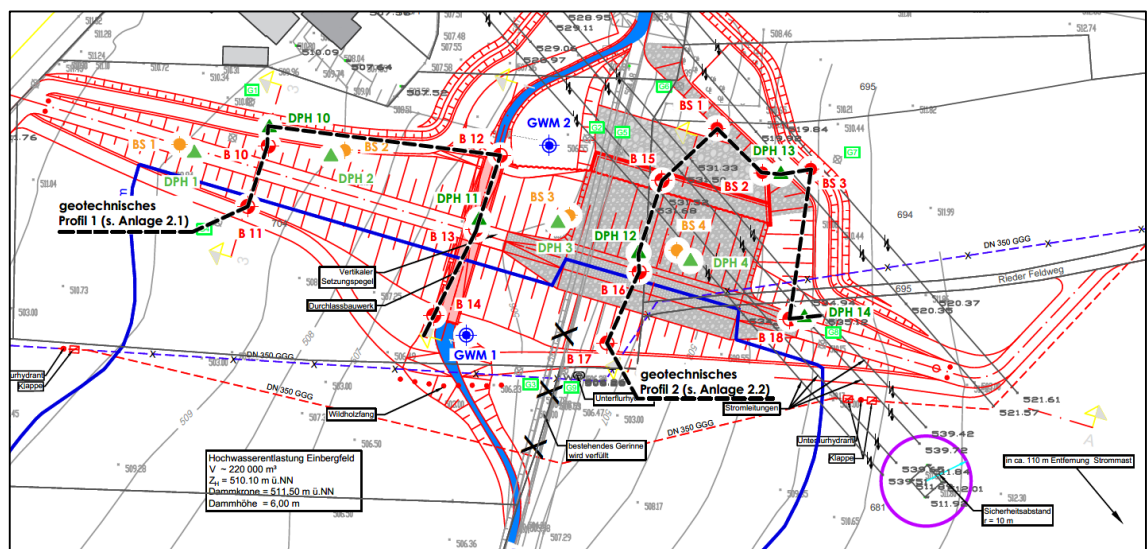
Ausschnitt Lageplan des Untersuchungsgebiets [G2]
